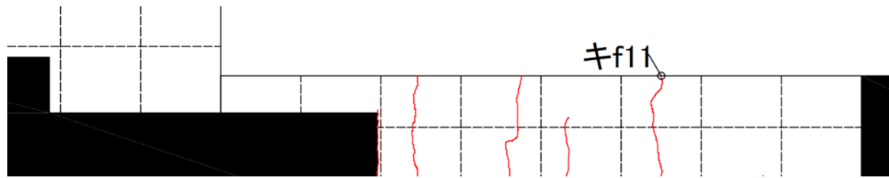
南基礎梁ひび割れ幅測定位置(試験体 DR-5 -7.0 サイクル 上面)
